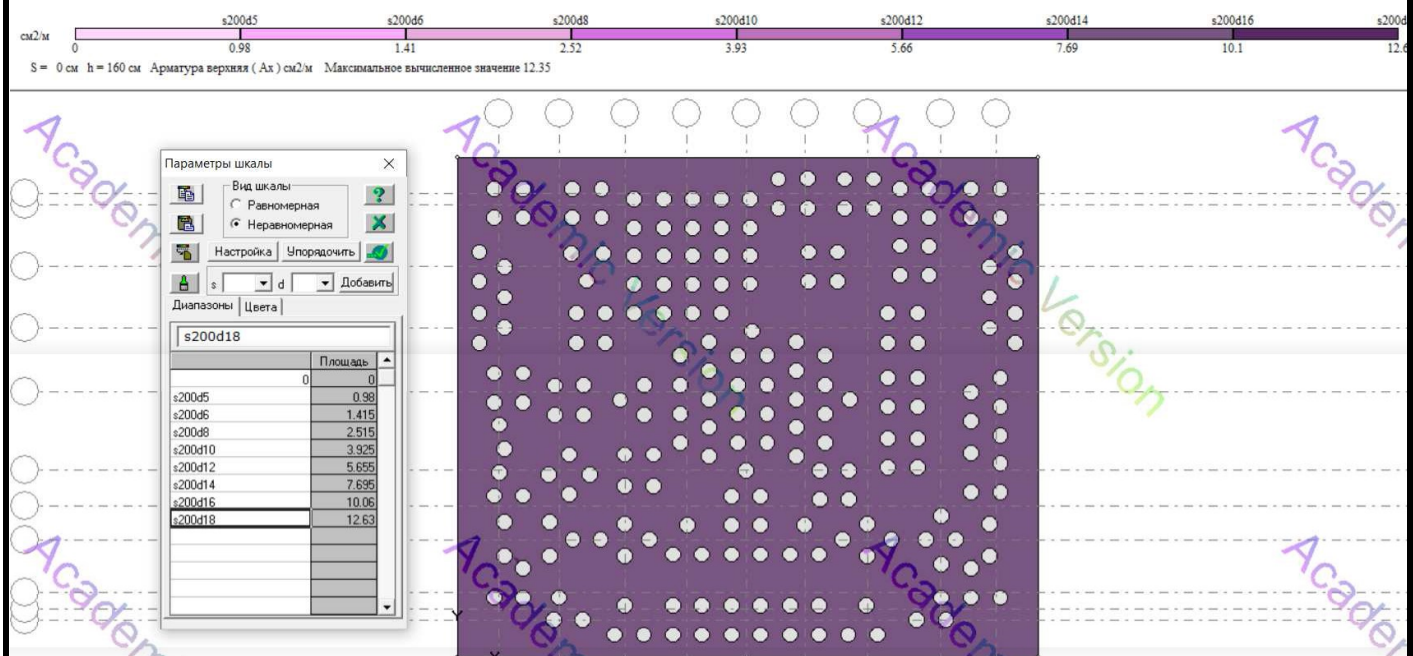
Армования зоны верхней фундаментной плиты каркасно-монолитного многоэтажного здания вдоль оси X
